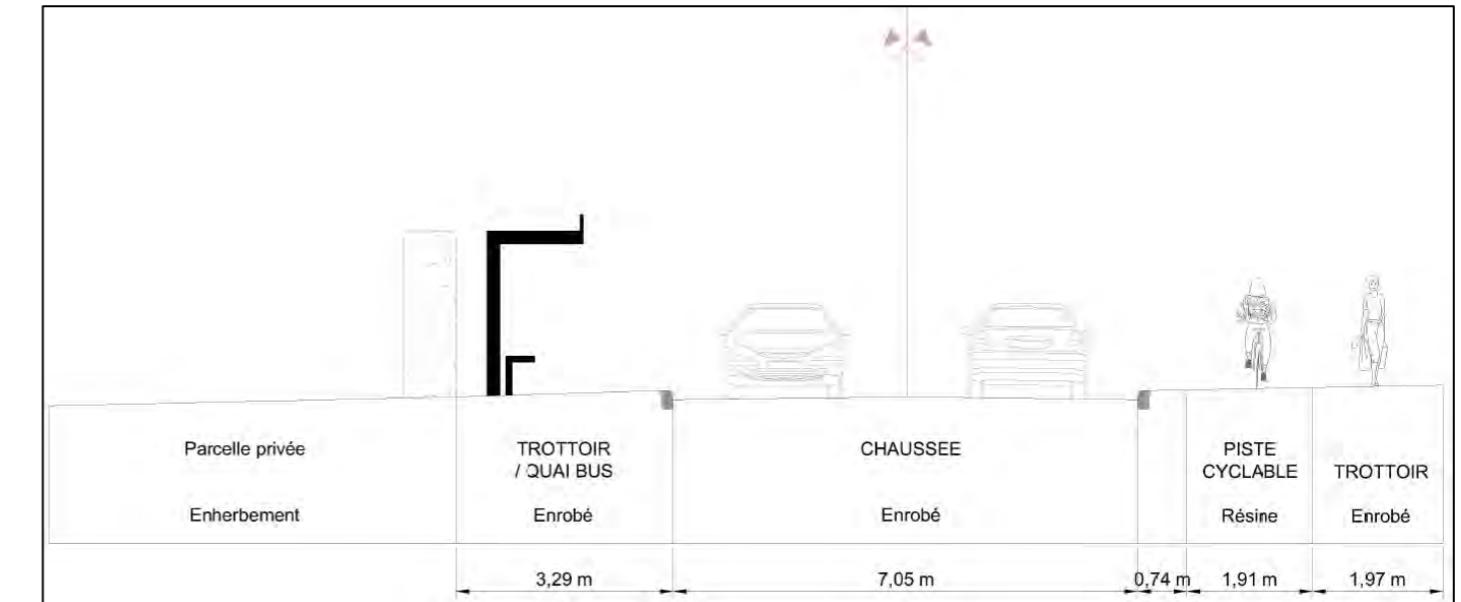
Avenue du Moulinat - Quai bus – Profil en travers existant – Setec / Signes Paysages
